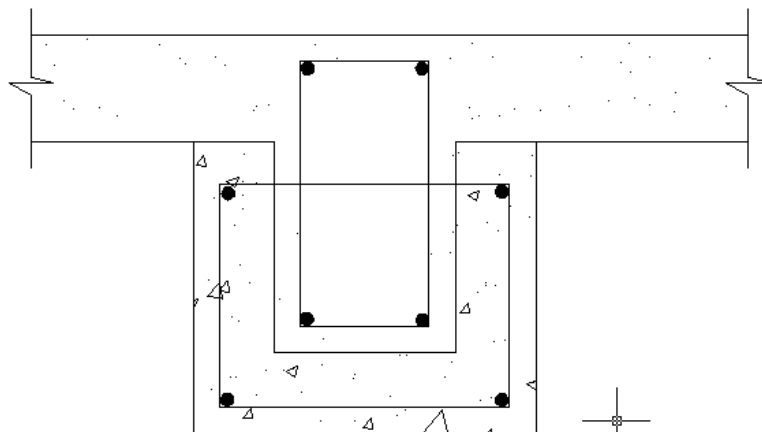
Vista en corte de la ubicación del acero de refuerzo.
